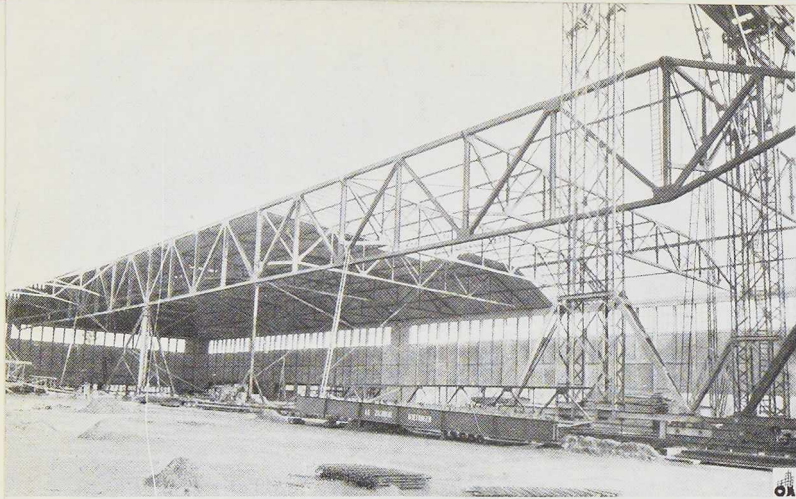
Montage des poutres de guidage des poutres du hangar de Cointrin-Genève.
